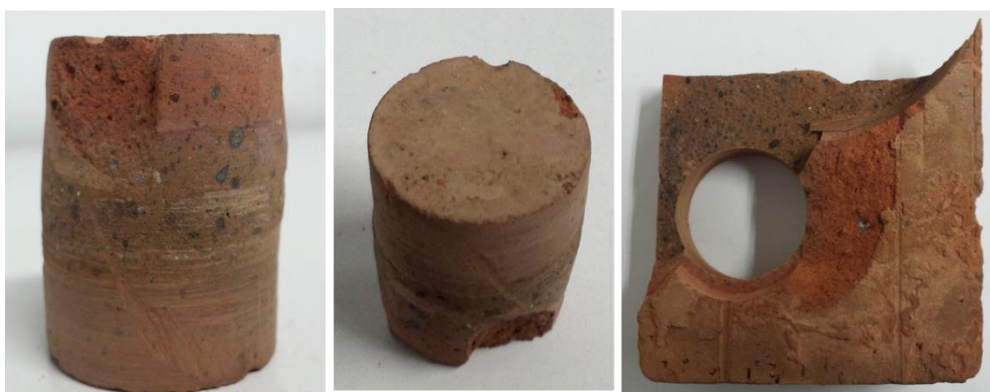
Ladrillo industrial 01 - Pieza pequeña
